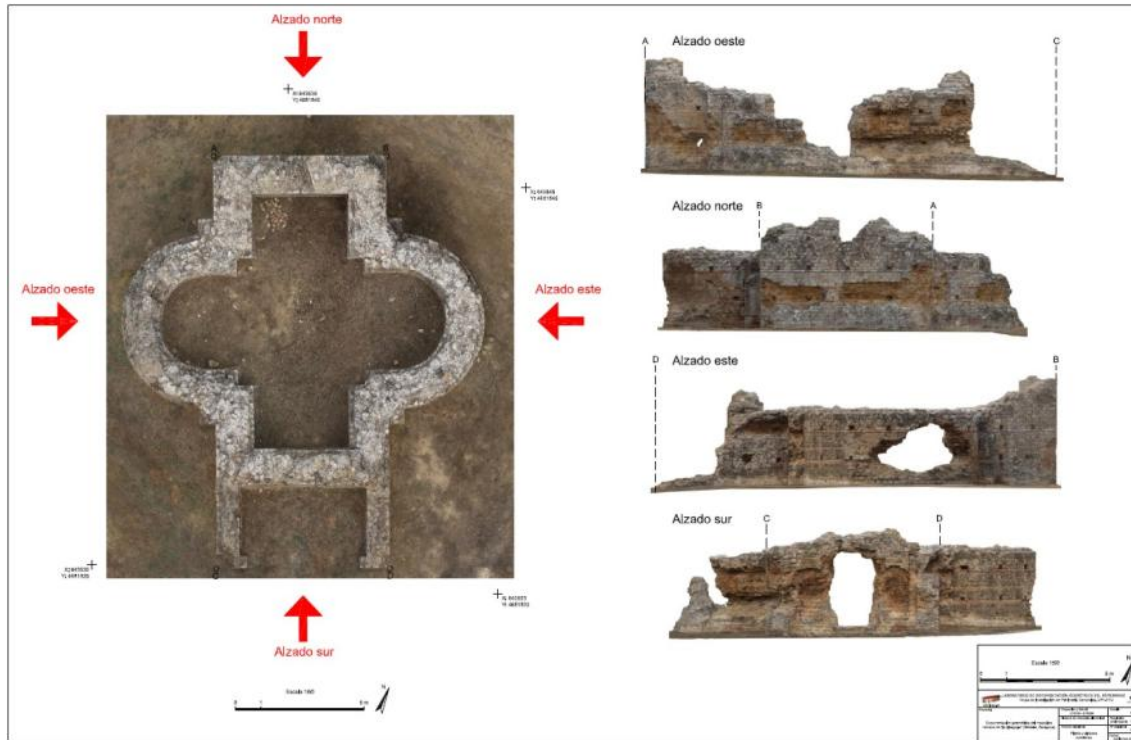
Plano con las ortoimágenes en planta y los diferentes alzados exteriores.
